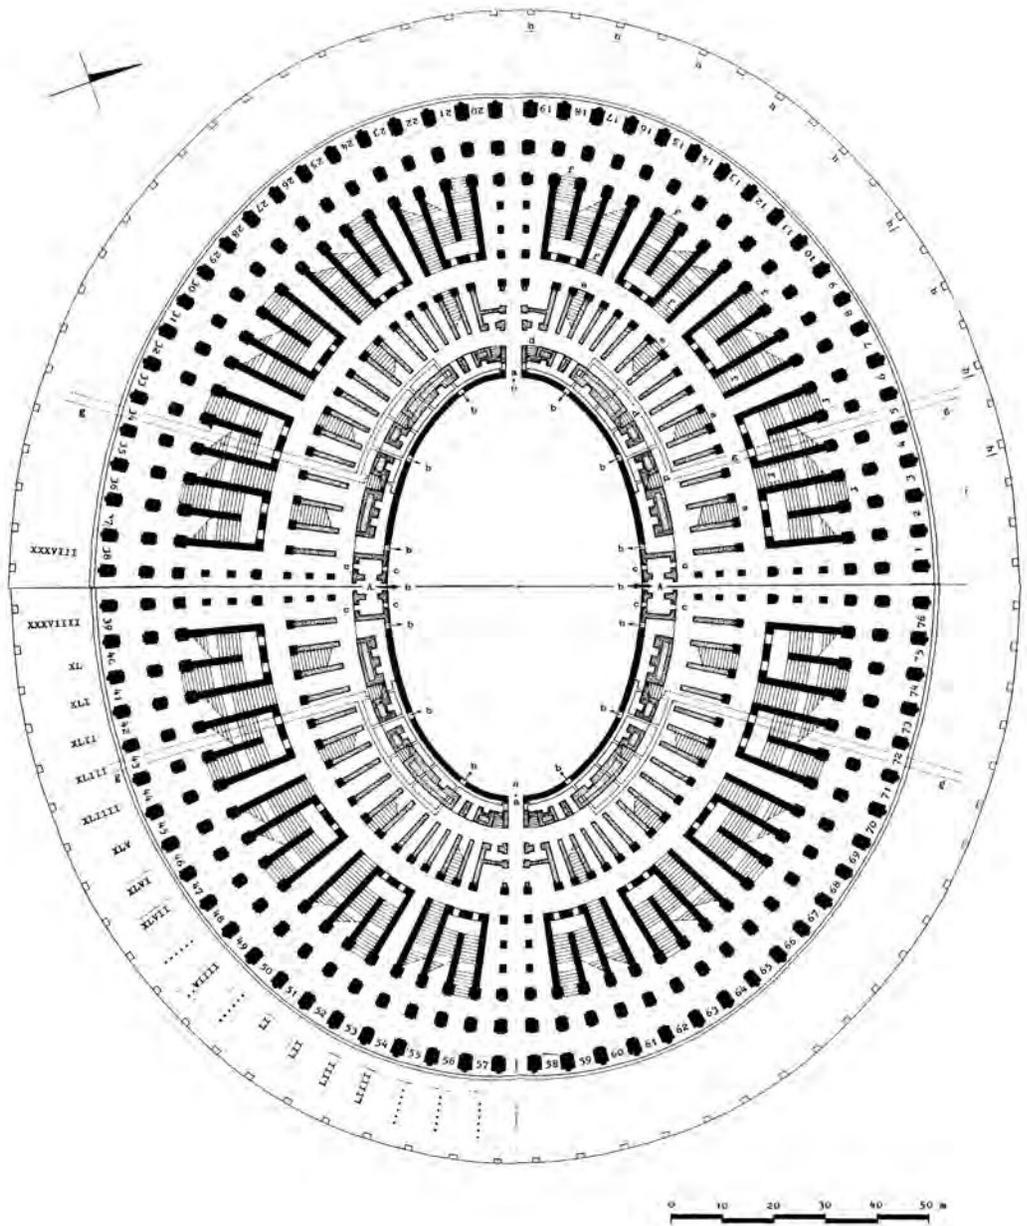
Rom, Kolosseum, Grundriss, Erdgeschoss
